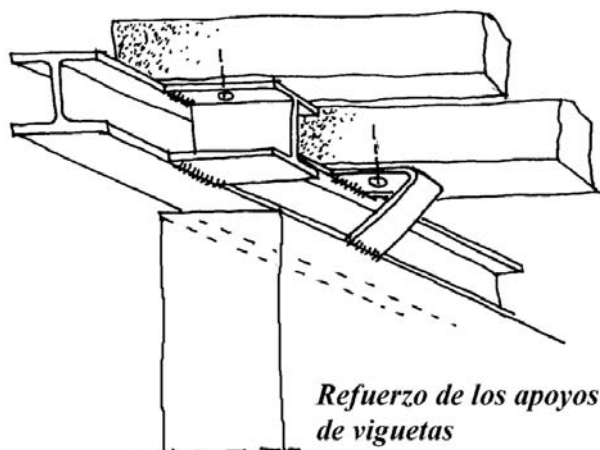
A/1. Si la carrera se sustituye por un perfil de acero laminado se puede reforzar el apoyo de las viguetas con ménsulas soldadas a la carrera
